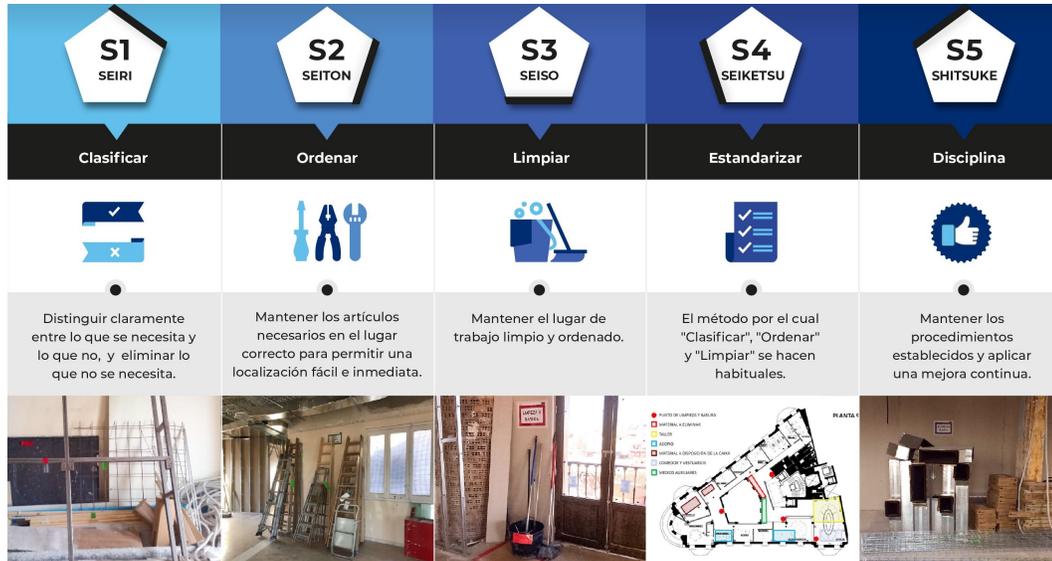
Ejemplo de aplicación de las 5“S” en construcción. [Fuente: Lean Construction - Implantación 5“S”, Coanfi].
